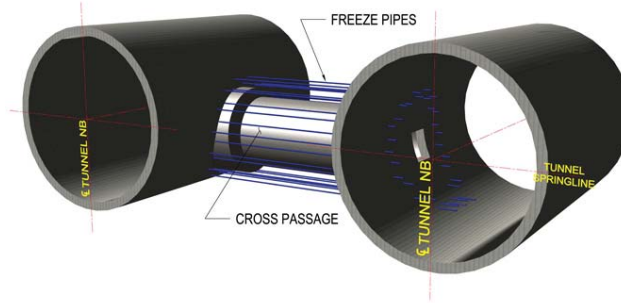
Consolidarea solului în cazul construcției unei galerii de legătură utilizând sonde orizontale
